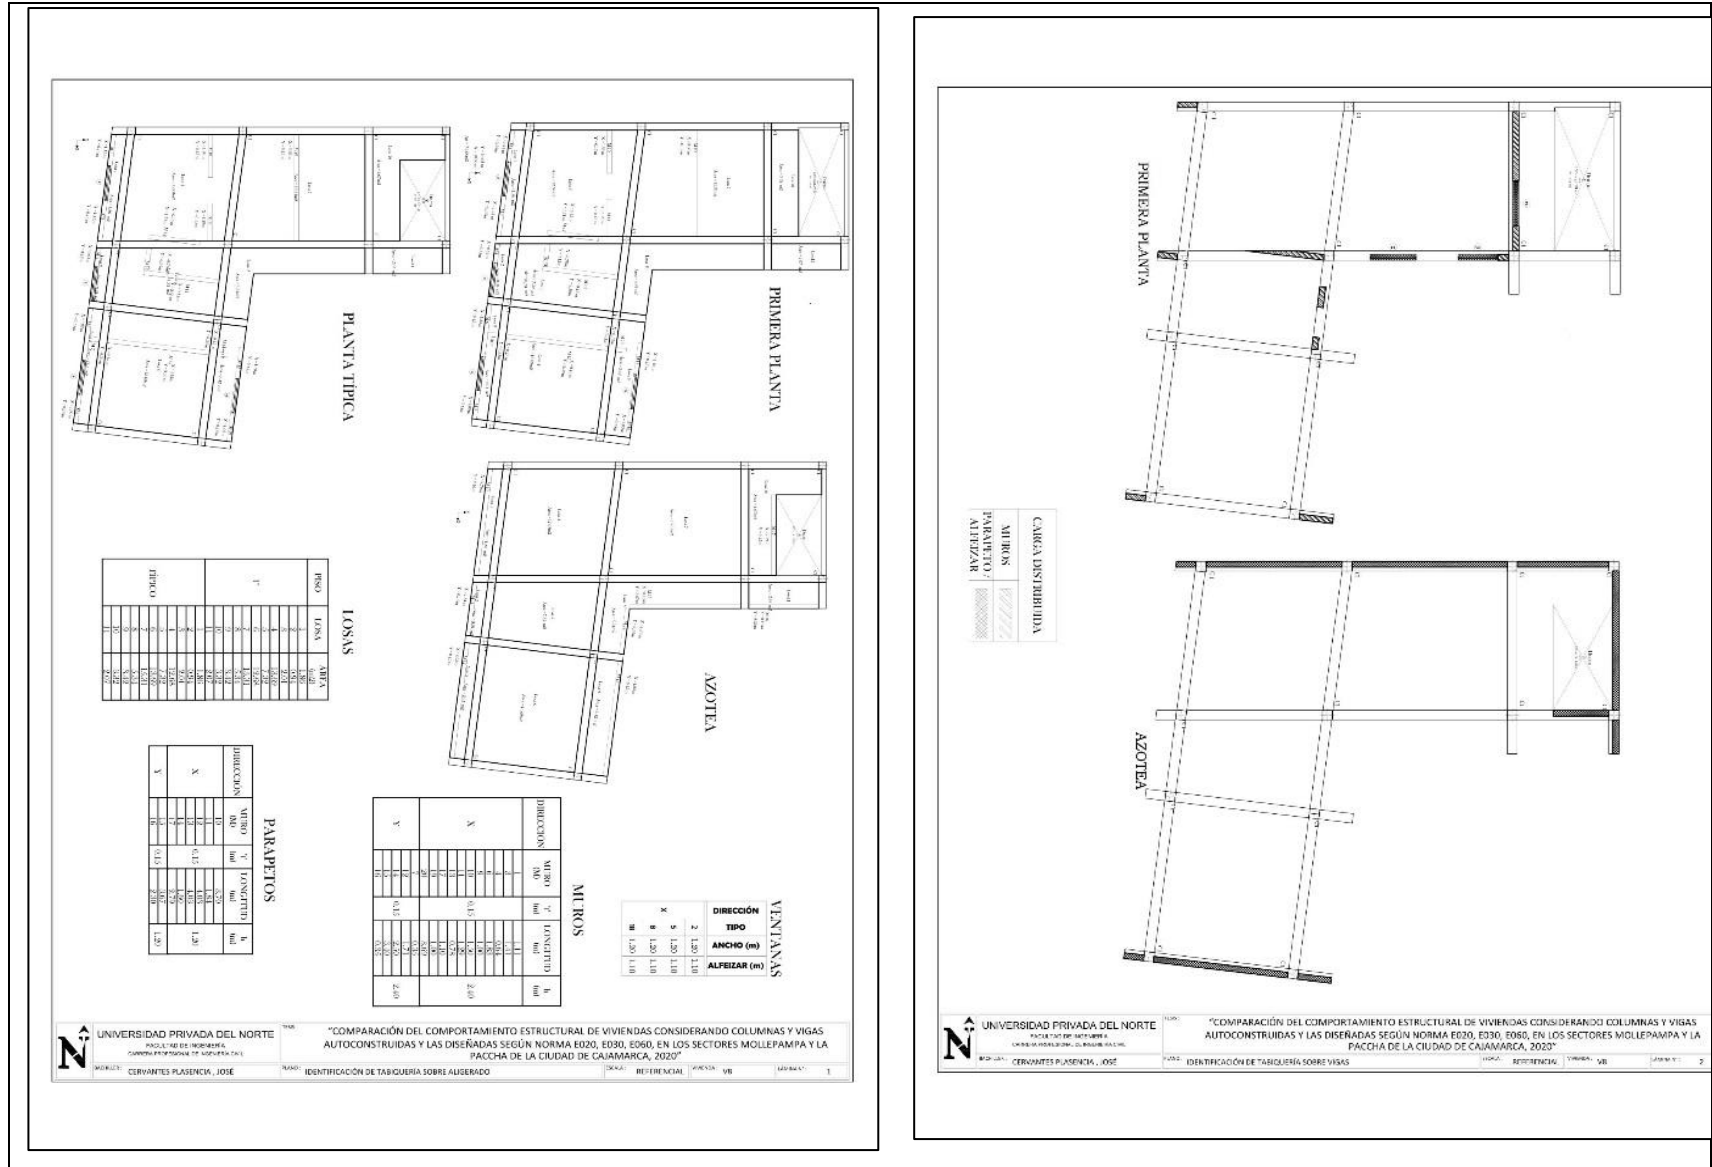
Tabiquería sobre losa aligerada y vigas vivienda 8
